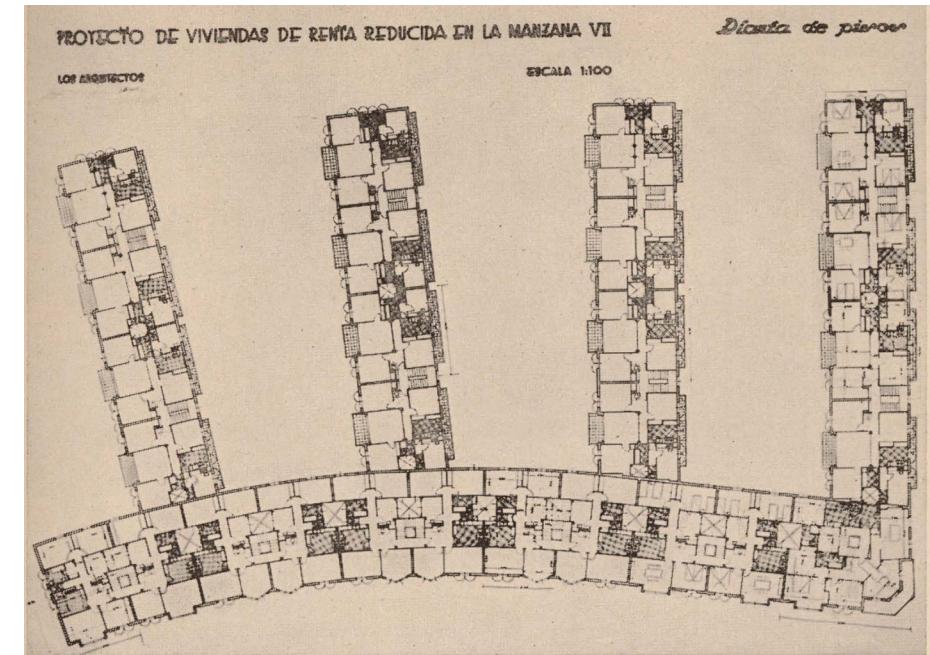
Planta tipo del proyecto de viviendas de renta limitada en la manzana VII, Eibar (1941). Fuente: *Reconstrucción*, 6, 1940
